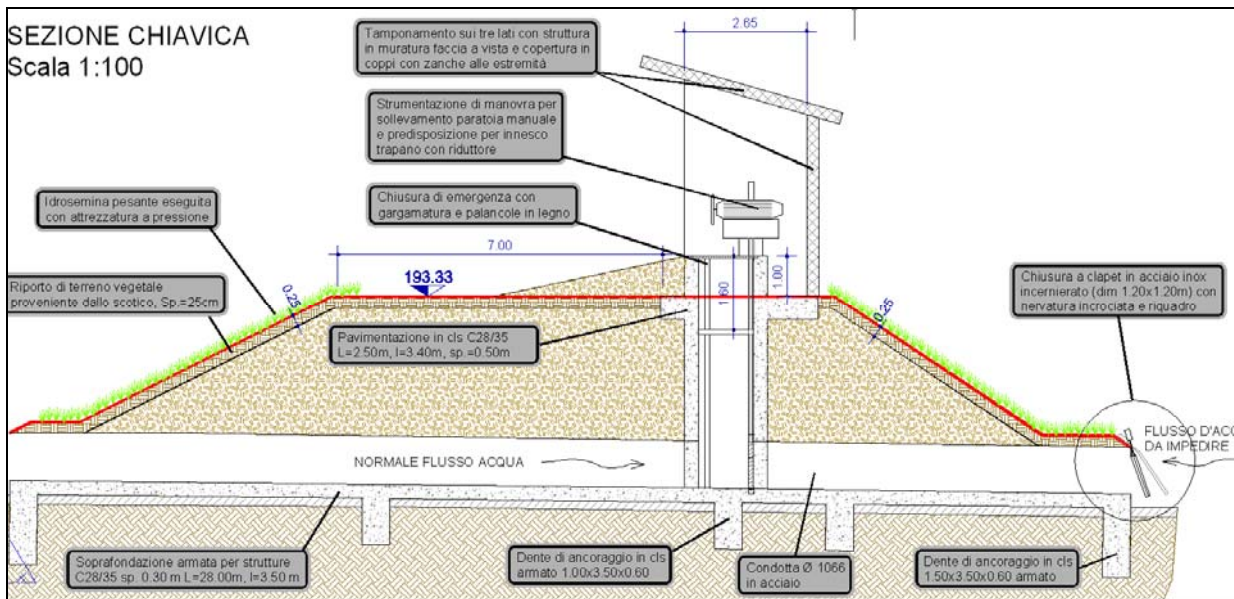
SEZIONE TIPOLOGICA STRUTTURA CHIAVICALE
